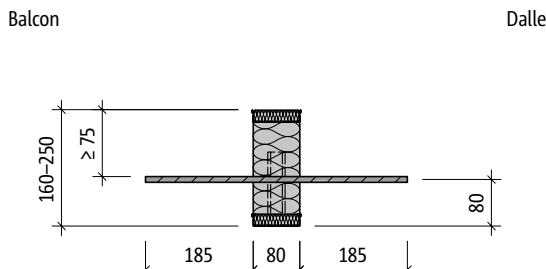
Schöck Isokorb® T Type H-NN1 : Coupe du produit
